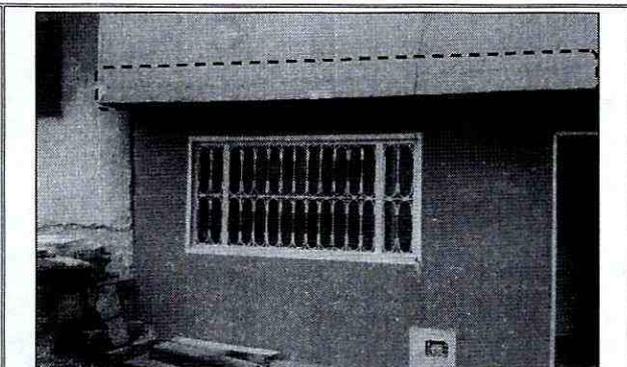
Fisuras de tendencia horizontal evidenciada en el predio de la Carrera 5F Este No. 88-03 Sur (RO-71950 – Junio de 2014)
